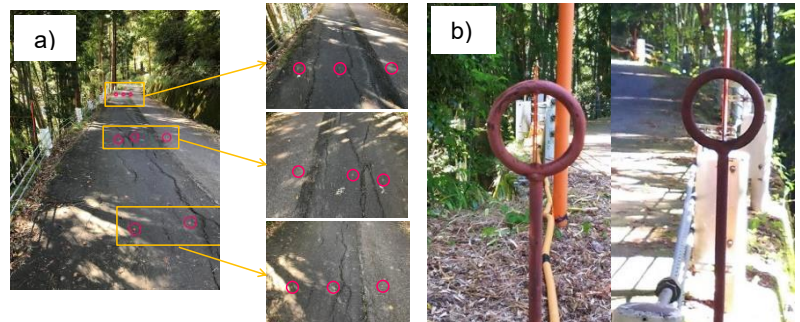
新規追加の計測機器、(a) ひび割れ計測用の鋺、(b) 見通し棒
